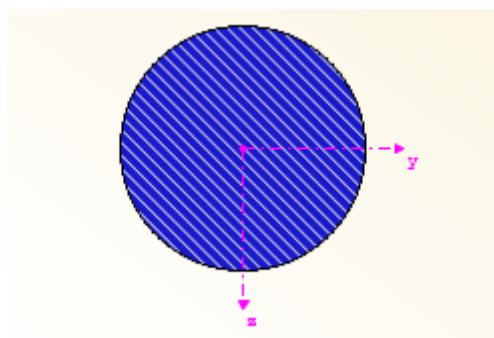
SECCIÓN DE LOS CABLES ST 1080/1230
